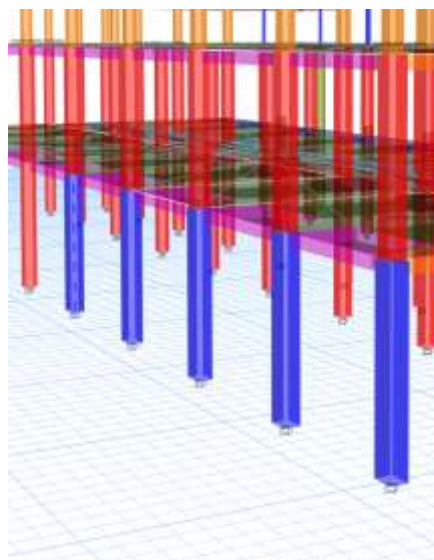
Adicción de columna reforzada en el modelo. Fuente: Propio.
